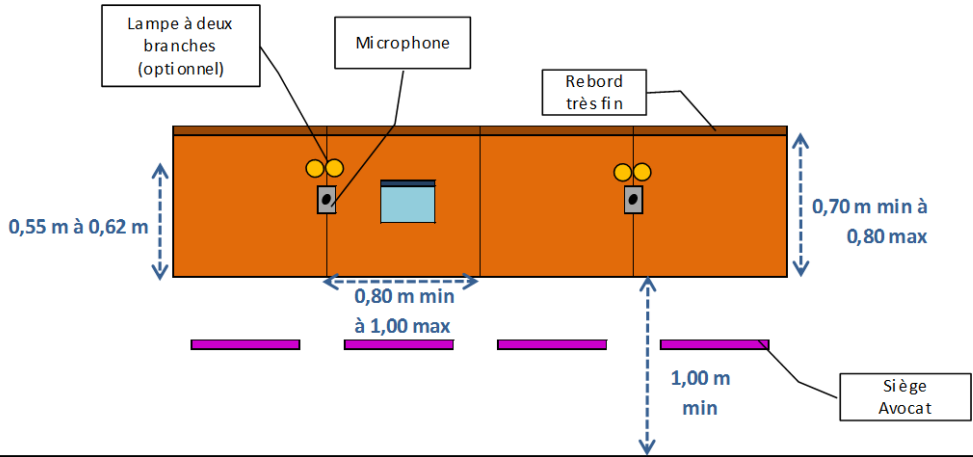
Coupe transversale, Positionnement de l'écran et hauteur de retour, en salles d'audience pénale.
